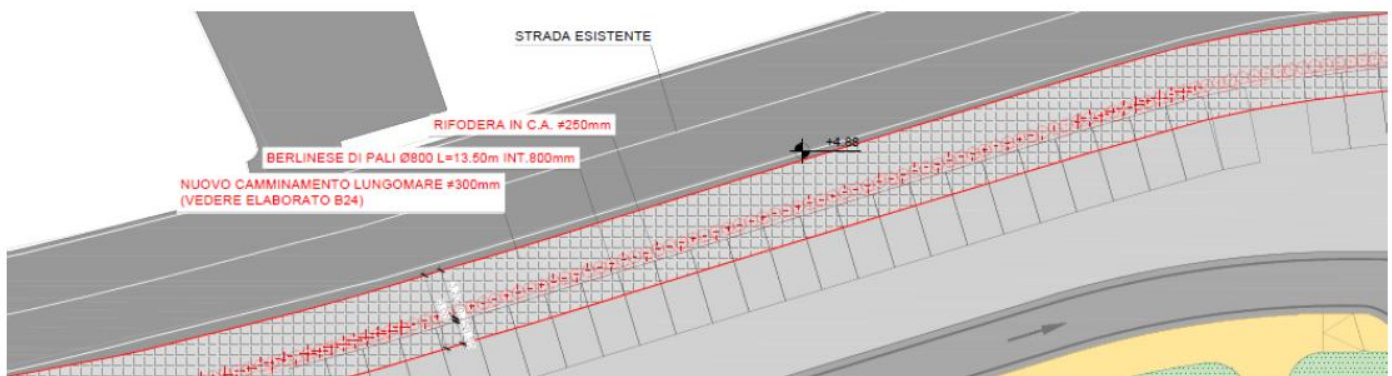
Estratto dalla tavola C10 "Planimetria strutturale di progetto"
